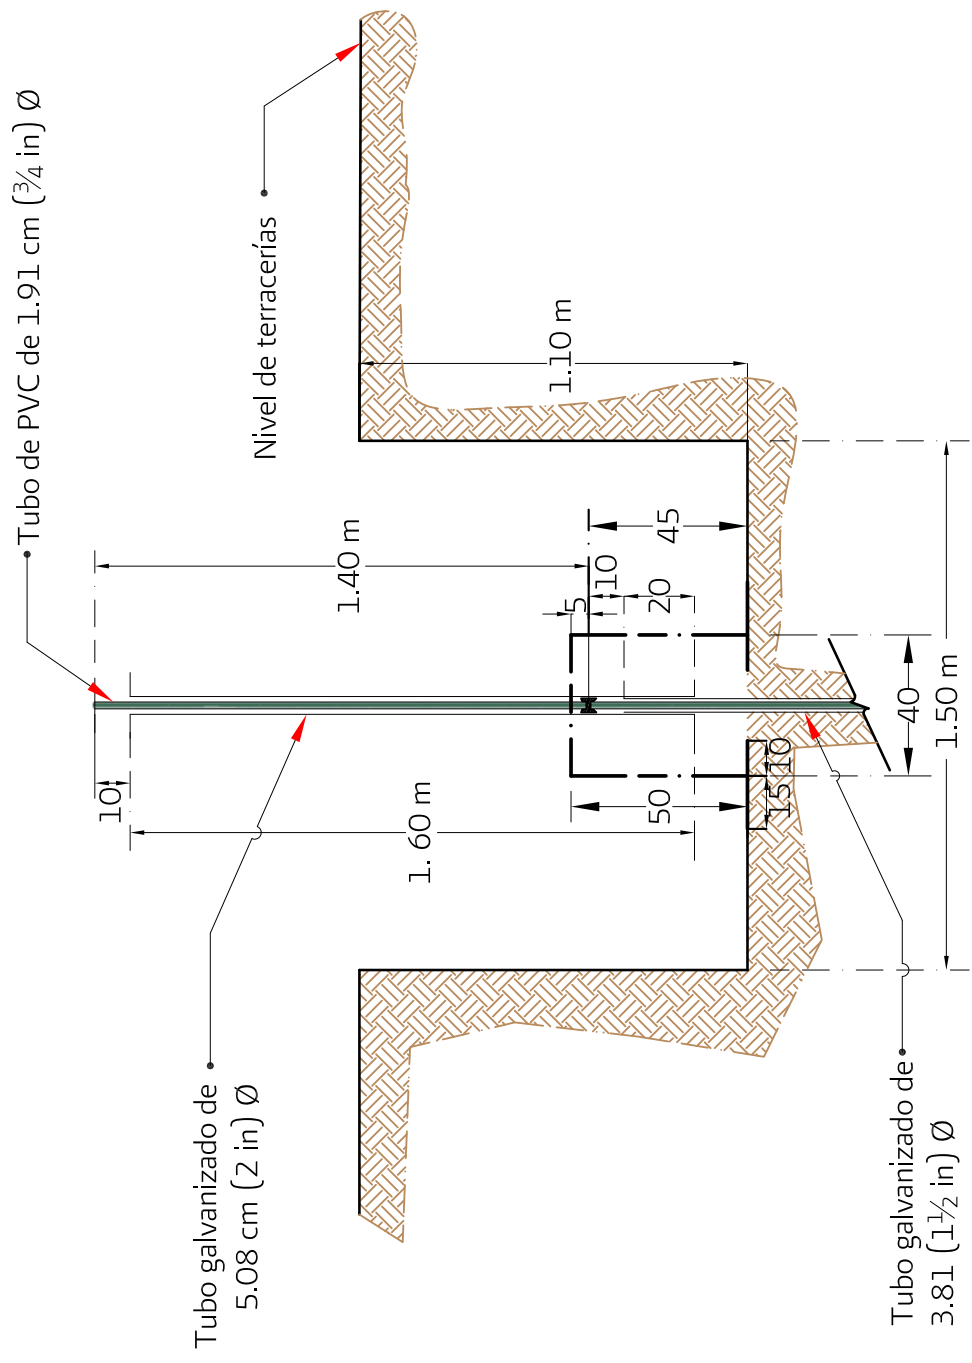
Etapas de protección de tuberías de piezómetro abierto durante la colocación de las terracerías en núcleo impermeable
